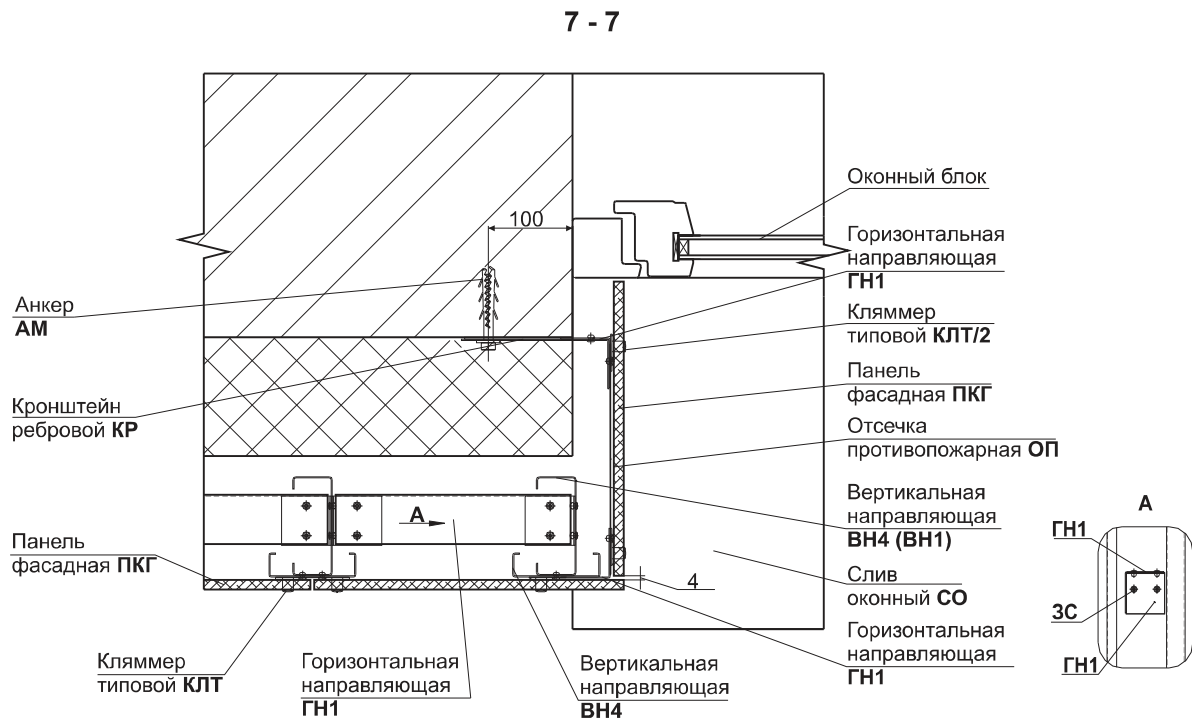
Узел облицовки бокового откоса панелями керамогранитными при креплении системы к междуэтажному перекрытию.
